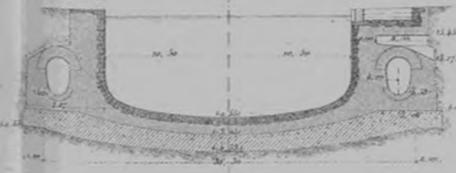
Demi-Elévation d'aval et demi-coupe 13.
